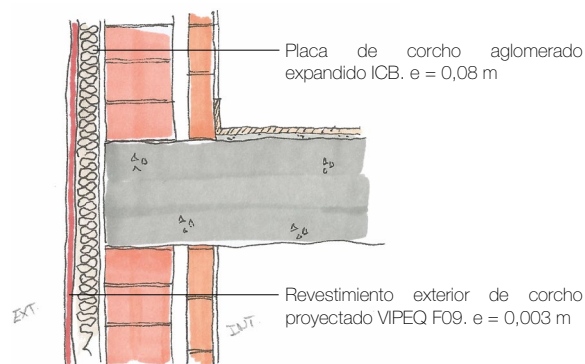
Sistema SATE aplicado al cerramiento vertical exterior. Encuentro pared de fachada con forjado (autoría propia).
